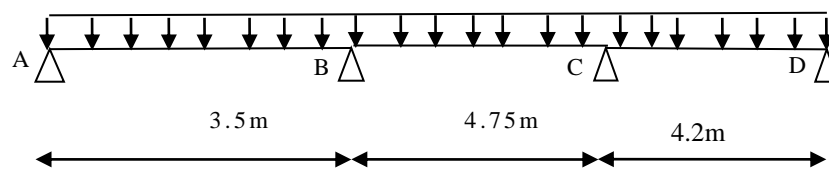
schéma statique d'une poutrelle du plancher étage service
